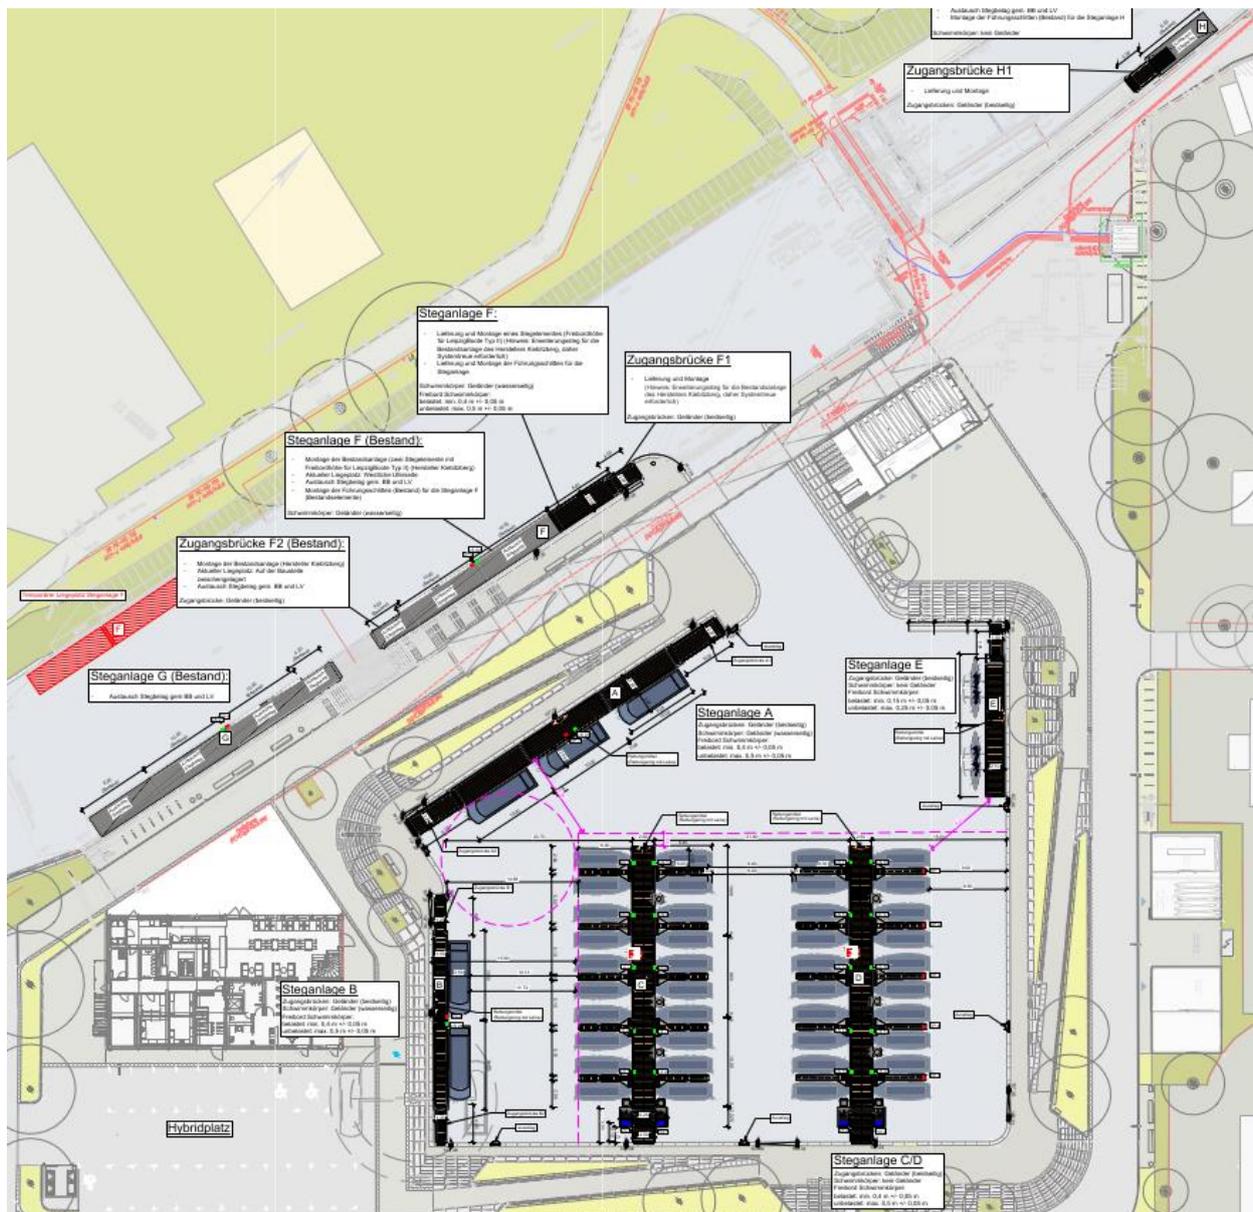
Übersichtslageplan Stadthafen und Steganlagen
